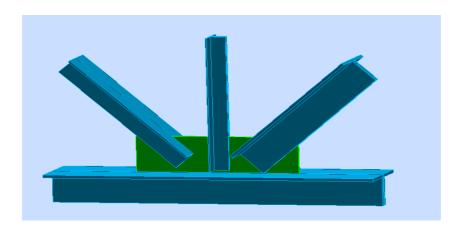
Détails d'assemblage des éléments de la ferme
